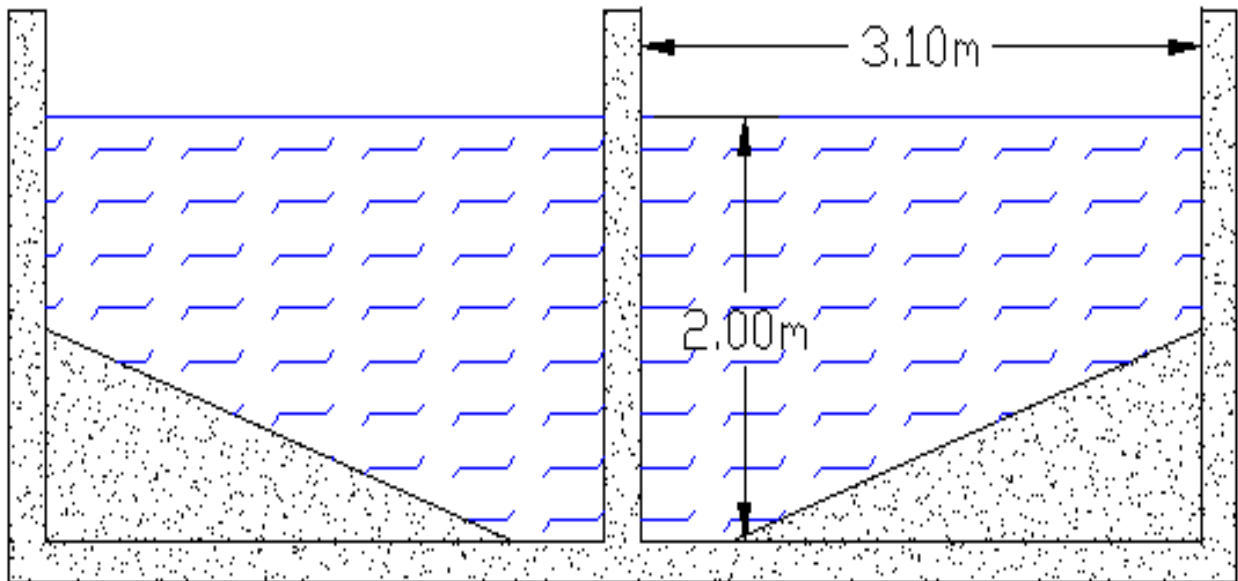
Coupe en travers du dessableur-déshuileur rectangulaire (AutoCAD)
